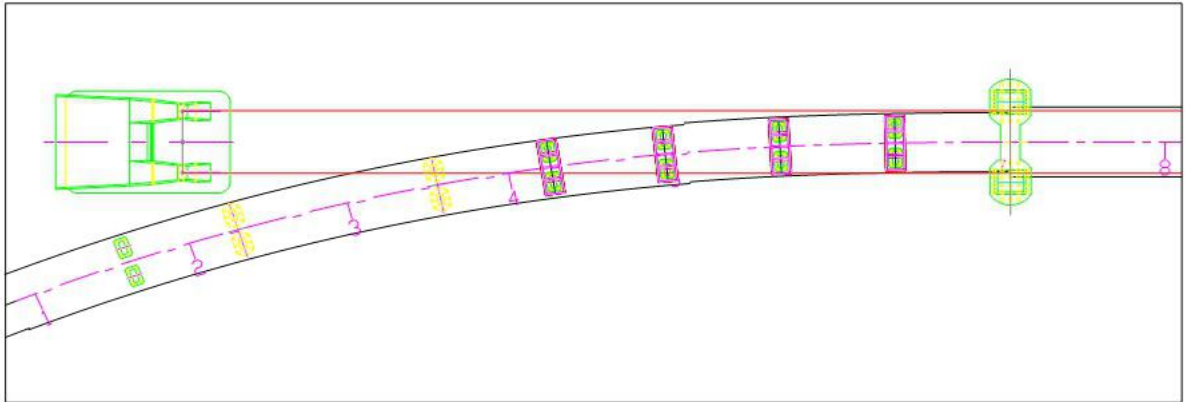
钢板桩围堰施工段引桥总体布置图
